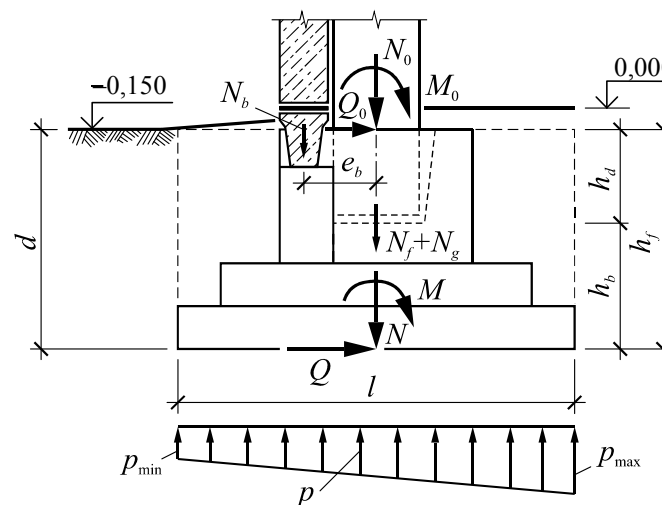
Расчетная схема к сбору нагрузок на основание отдельного фундамента для здания без подвала
